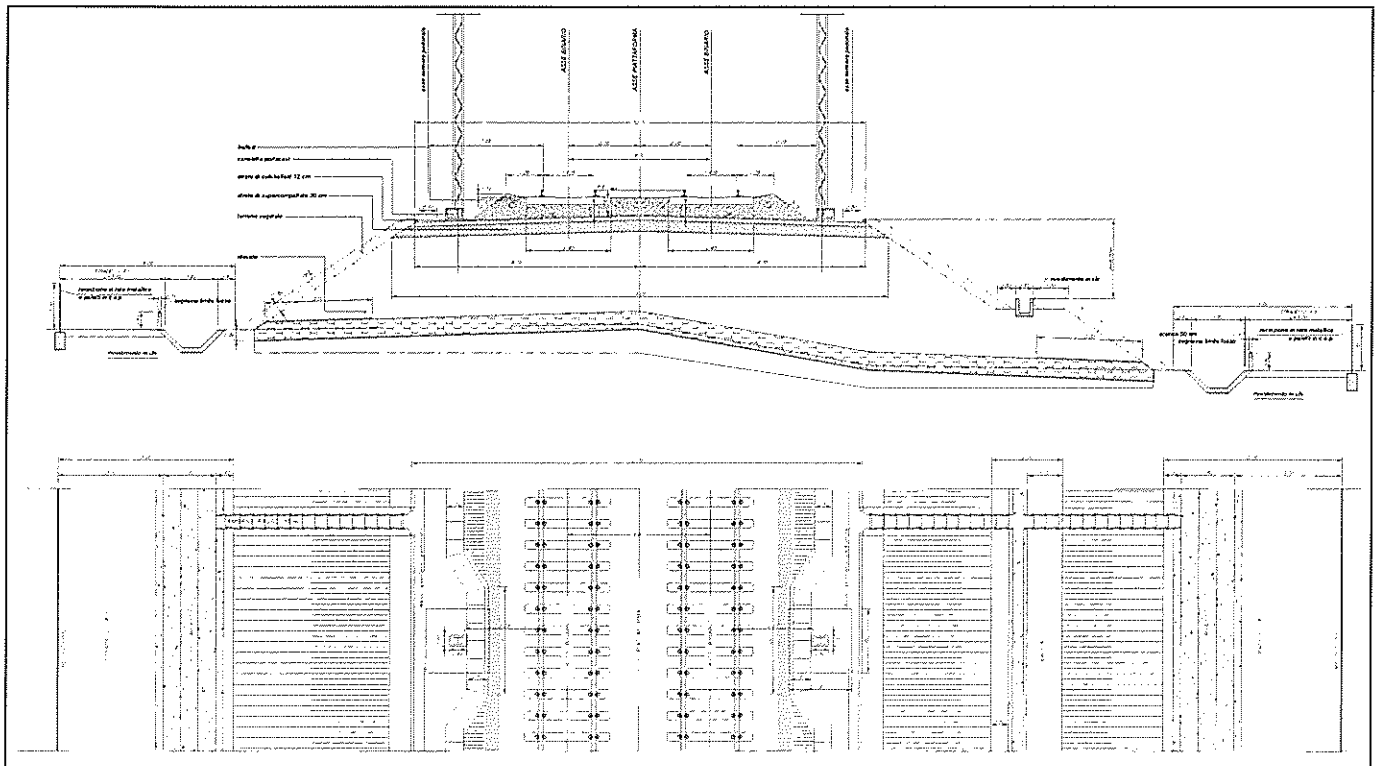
Sezione Tipo doppio binario in Rilevato - senza Barriere Antirumore –
